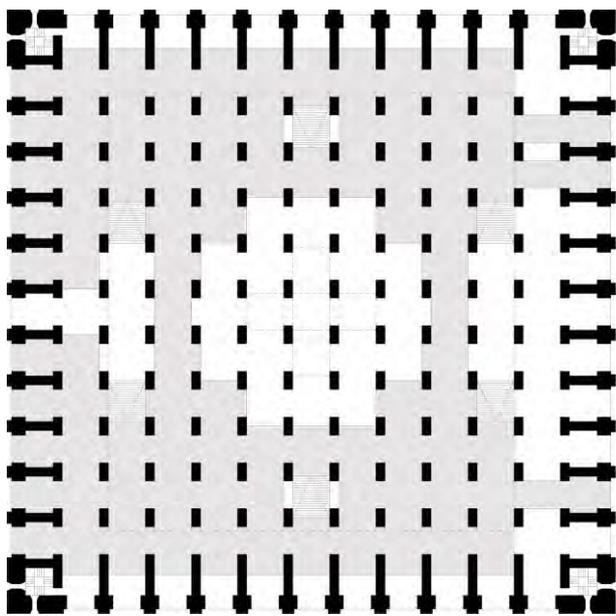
CLOTET-PARICIO, Planta entrepiso proyecto
